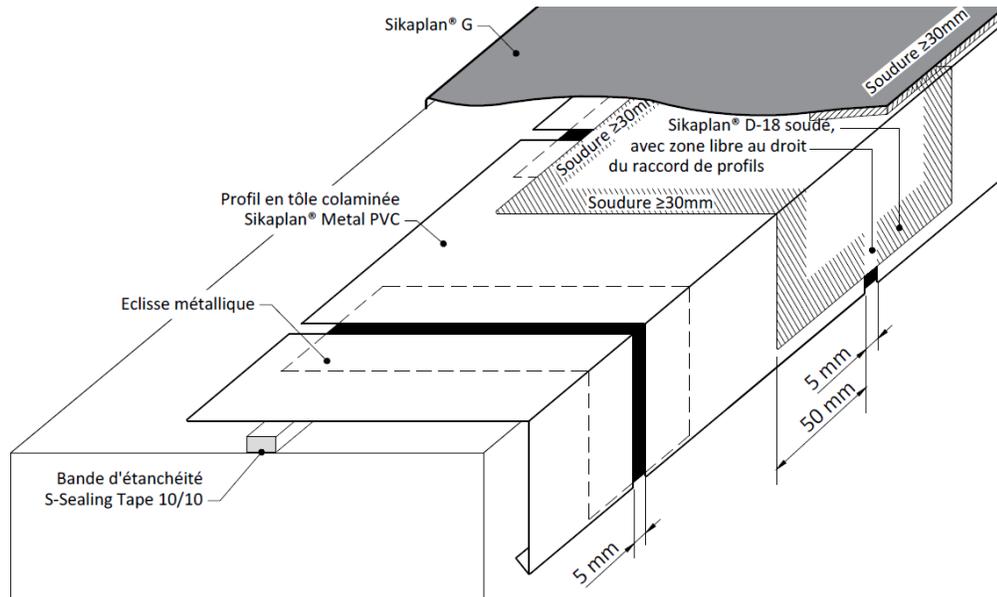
Jonction des profils en tôles colaminées Sikaplan® Metal PVC
